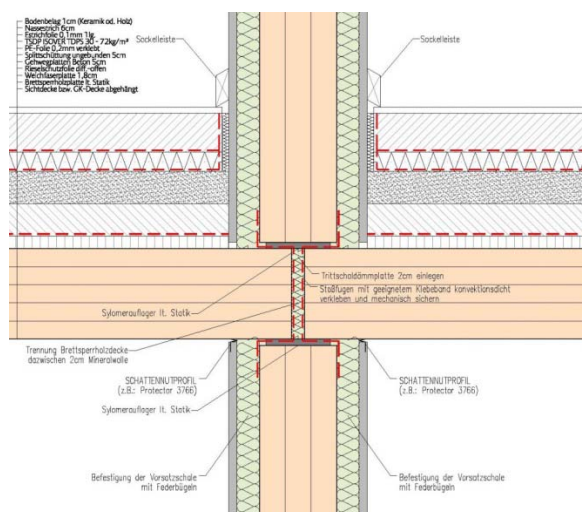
Anschlüsse Brettsper Holzdecke bzw. Wand Hotel Bauernhofer
